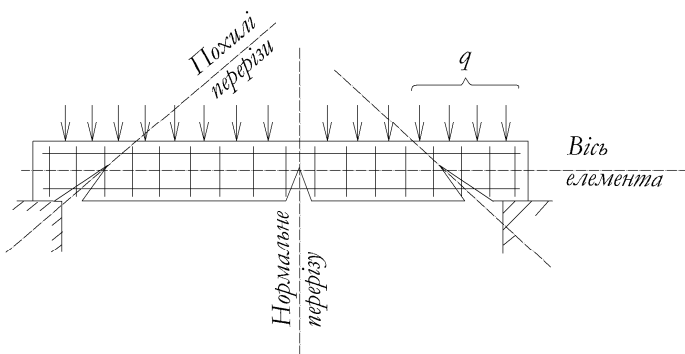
Руйнування балки по нормальному і похилому перерізу
